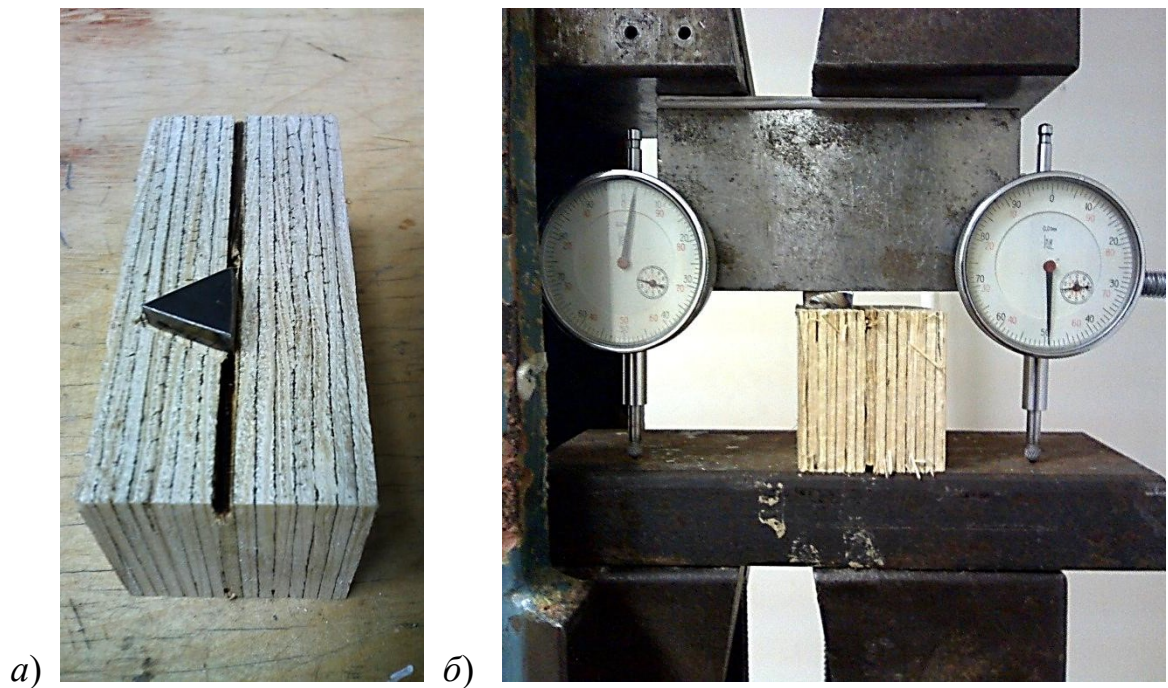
Проведение испытаний для получения коэффициента постели для *LVL* треугольным штампом а) образец *LVL* с пропилом; б) схема испытательной установки.
